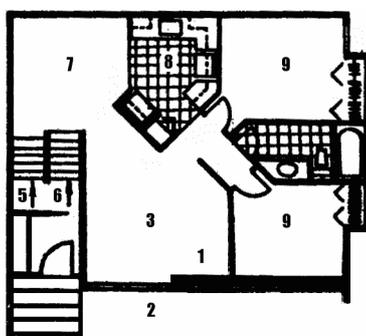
План жилого дома фирмы “Concept Construction” (Канада):
